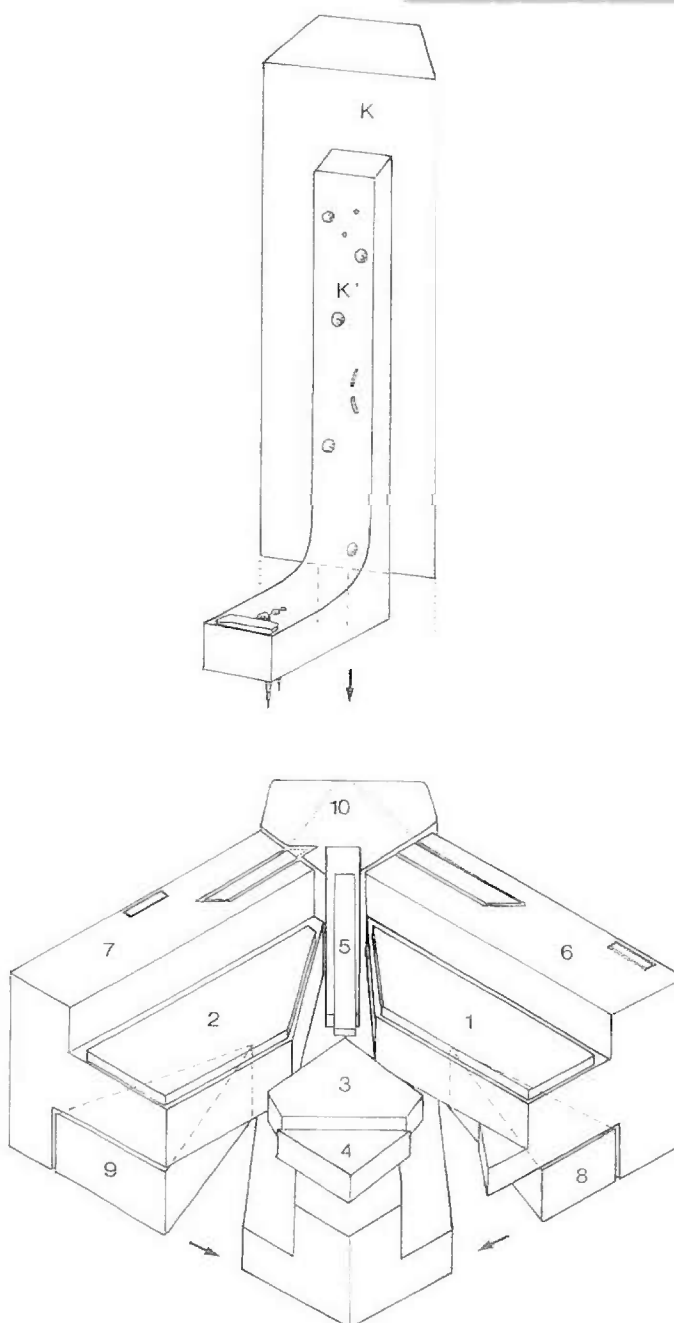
Chalon-sur-Saône, le pont Saint-Laurent. Écorché de la pointe du caisson étanche au niveau de l'avant-bec (essai) : K nez. « étrave » ; K' membrure ; 2 tenons (sans numéros) ; 1, 2 planchettes de sapin ; 3, 4 platelage ; 5 cale ; 6, 7 semelles ; 8, 9 plancher ; 10 quille.
